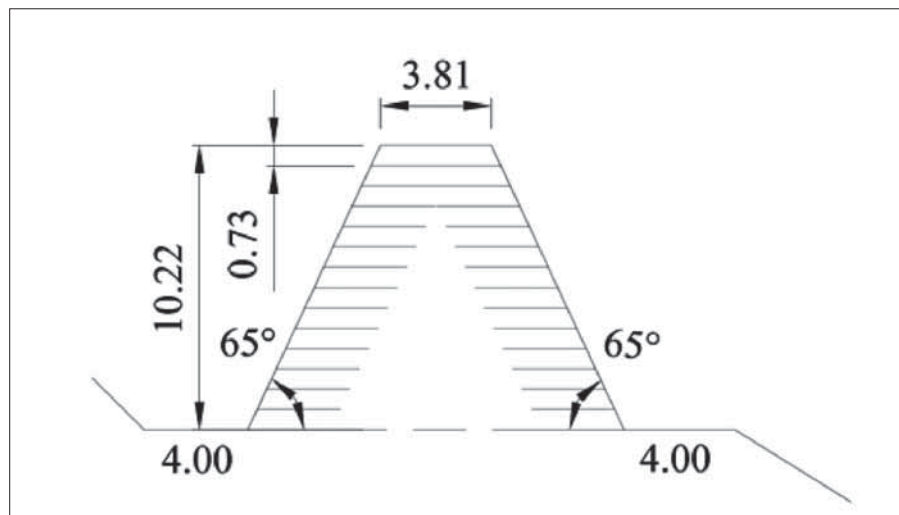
Schema della sezione geometrica dei rilevati paramassi realizzati.
